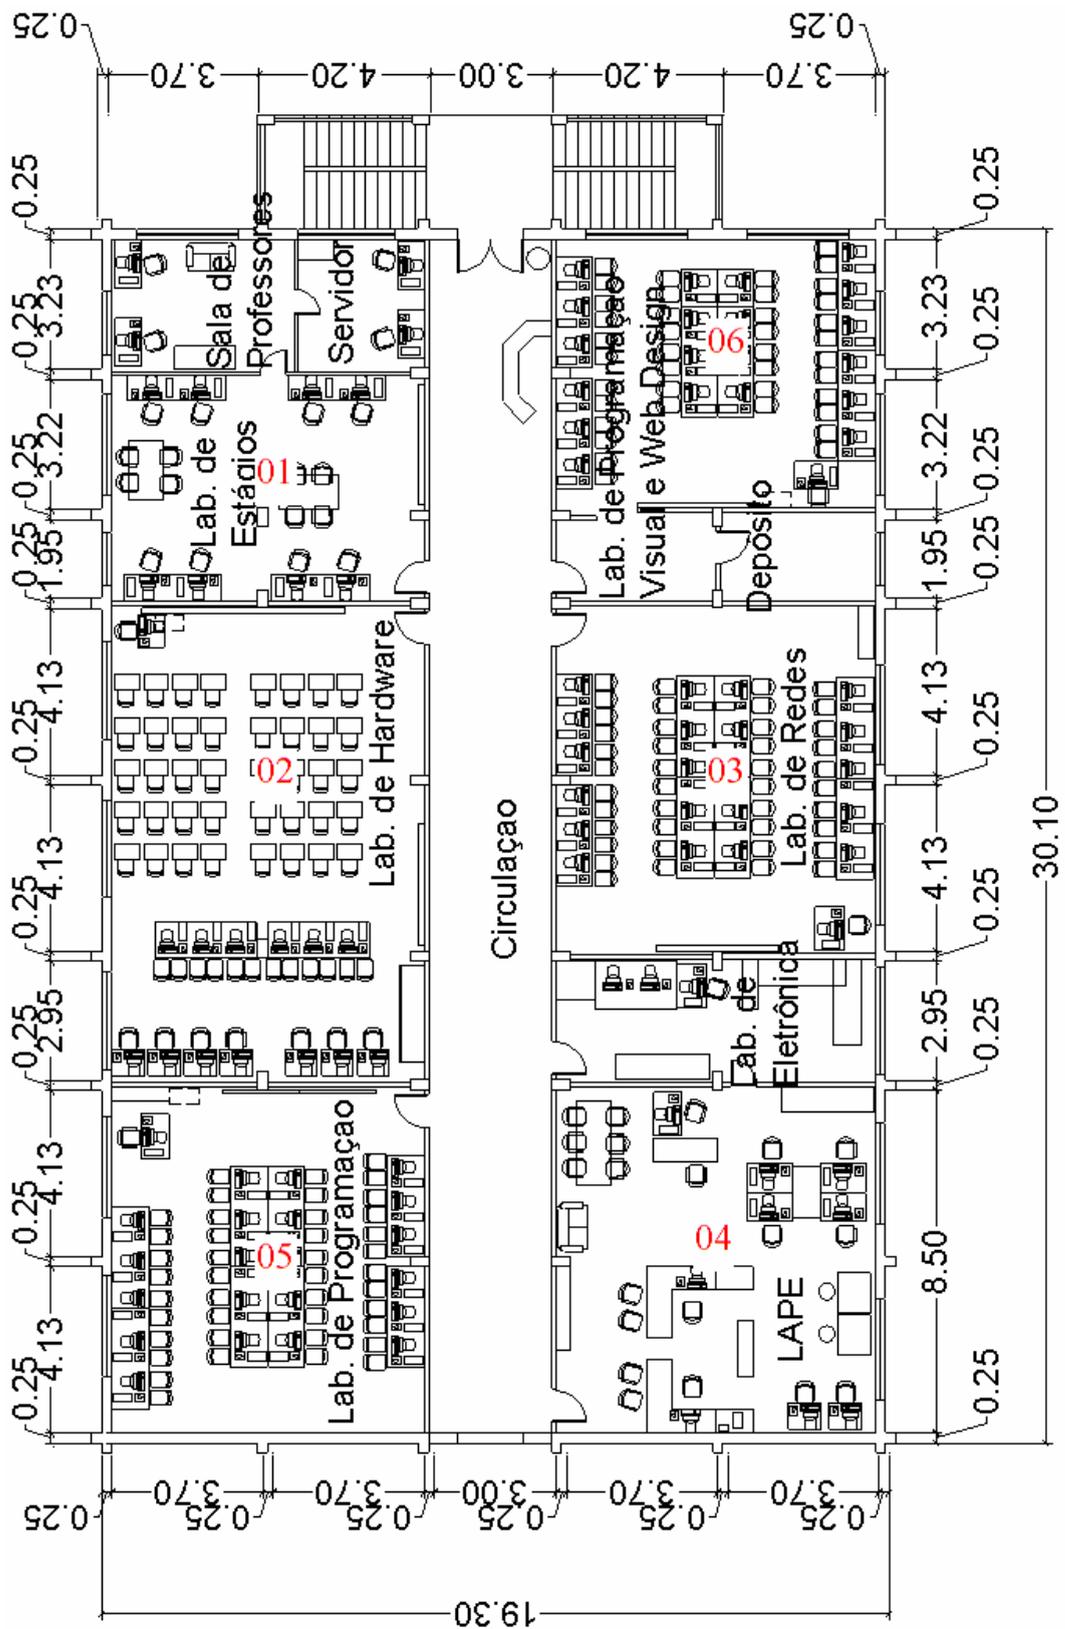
Planta baixa do primeiro pavimento do bloco de laboratórios
